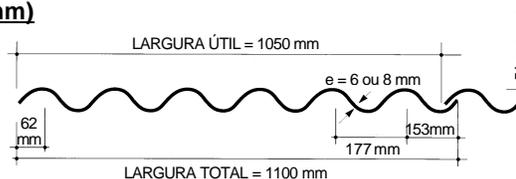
Telhas onduladas de 6 mm e 8 mm - Seção transversal.
